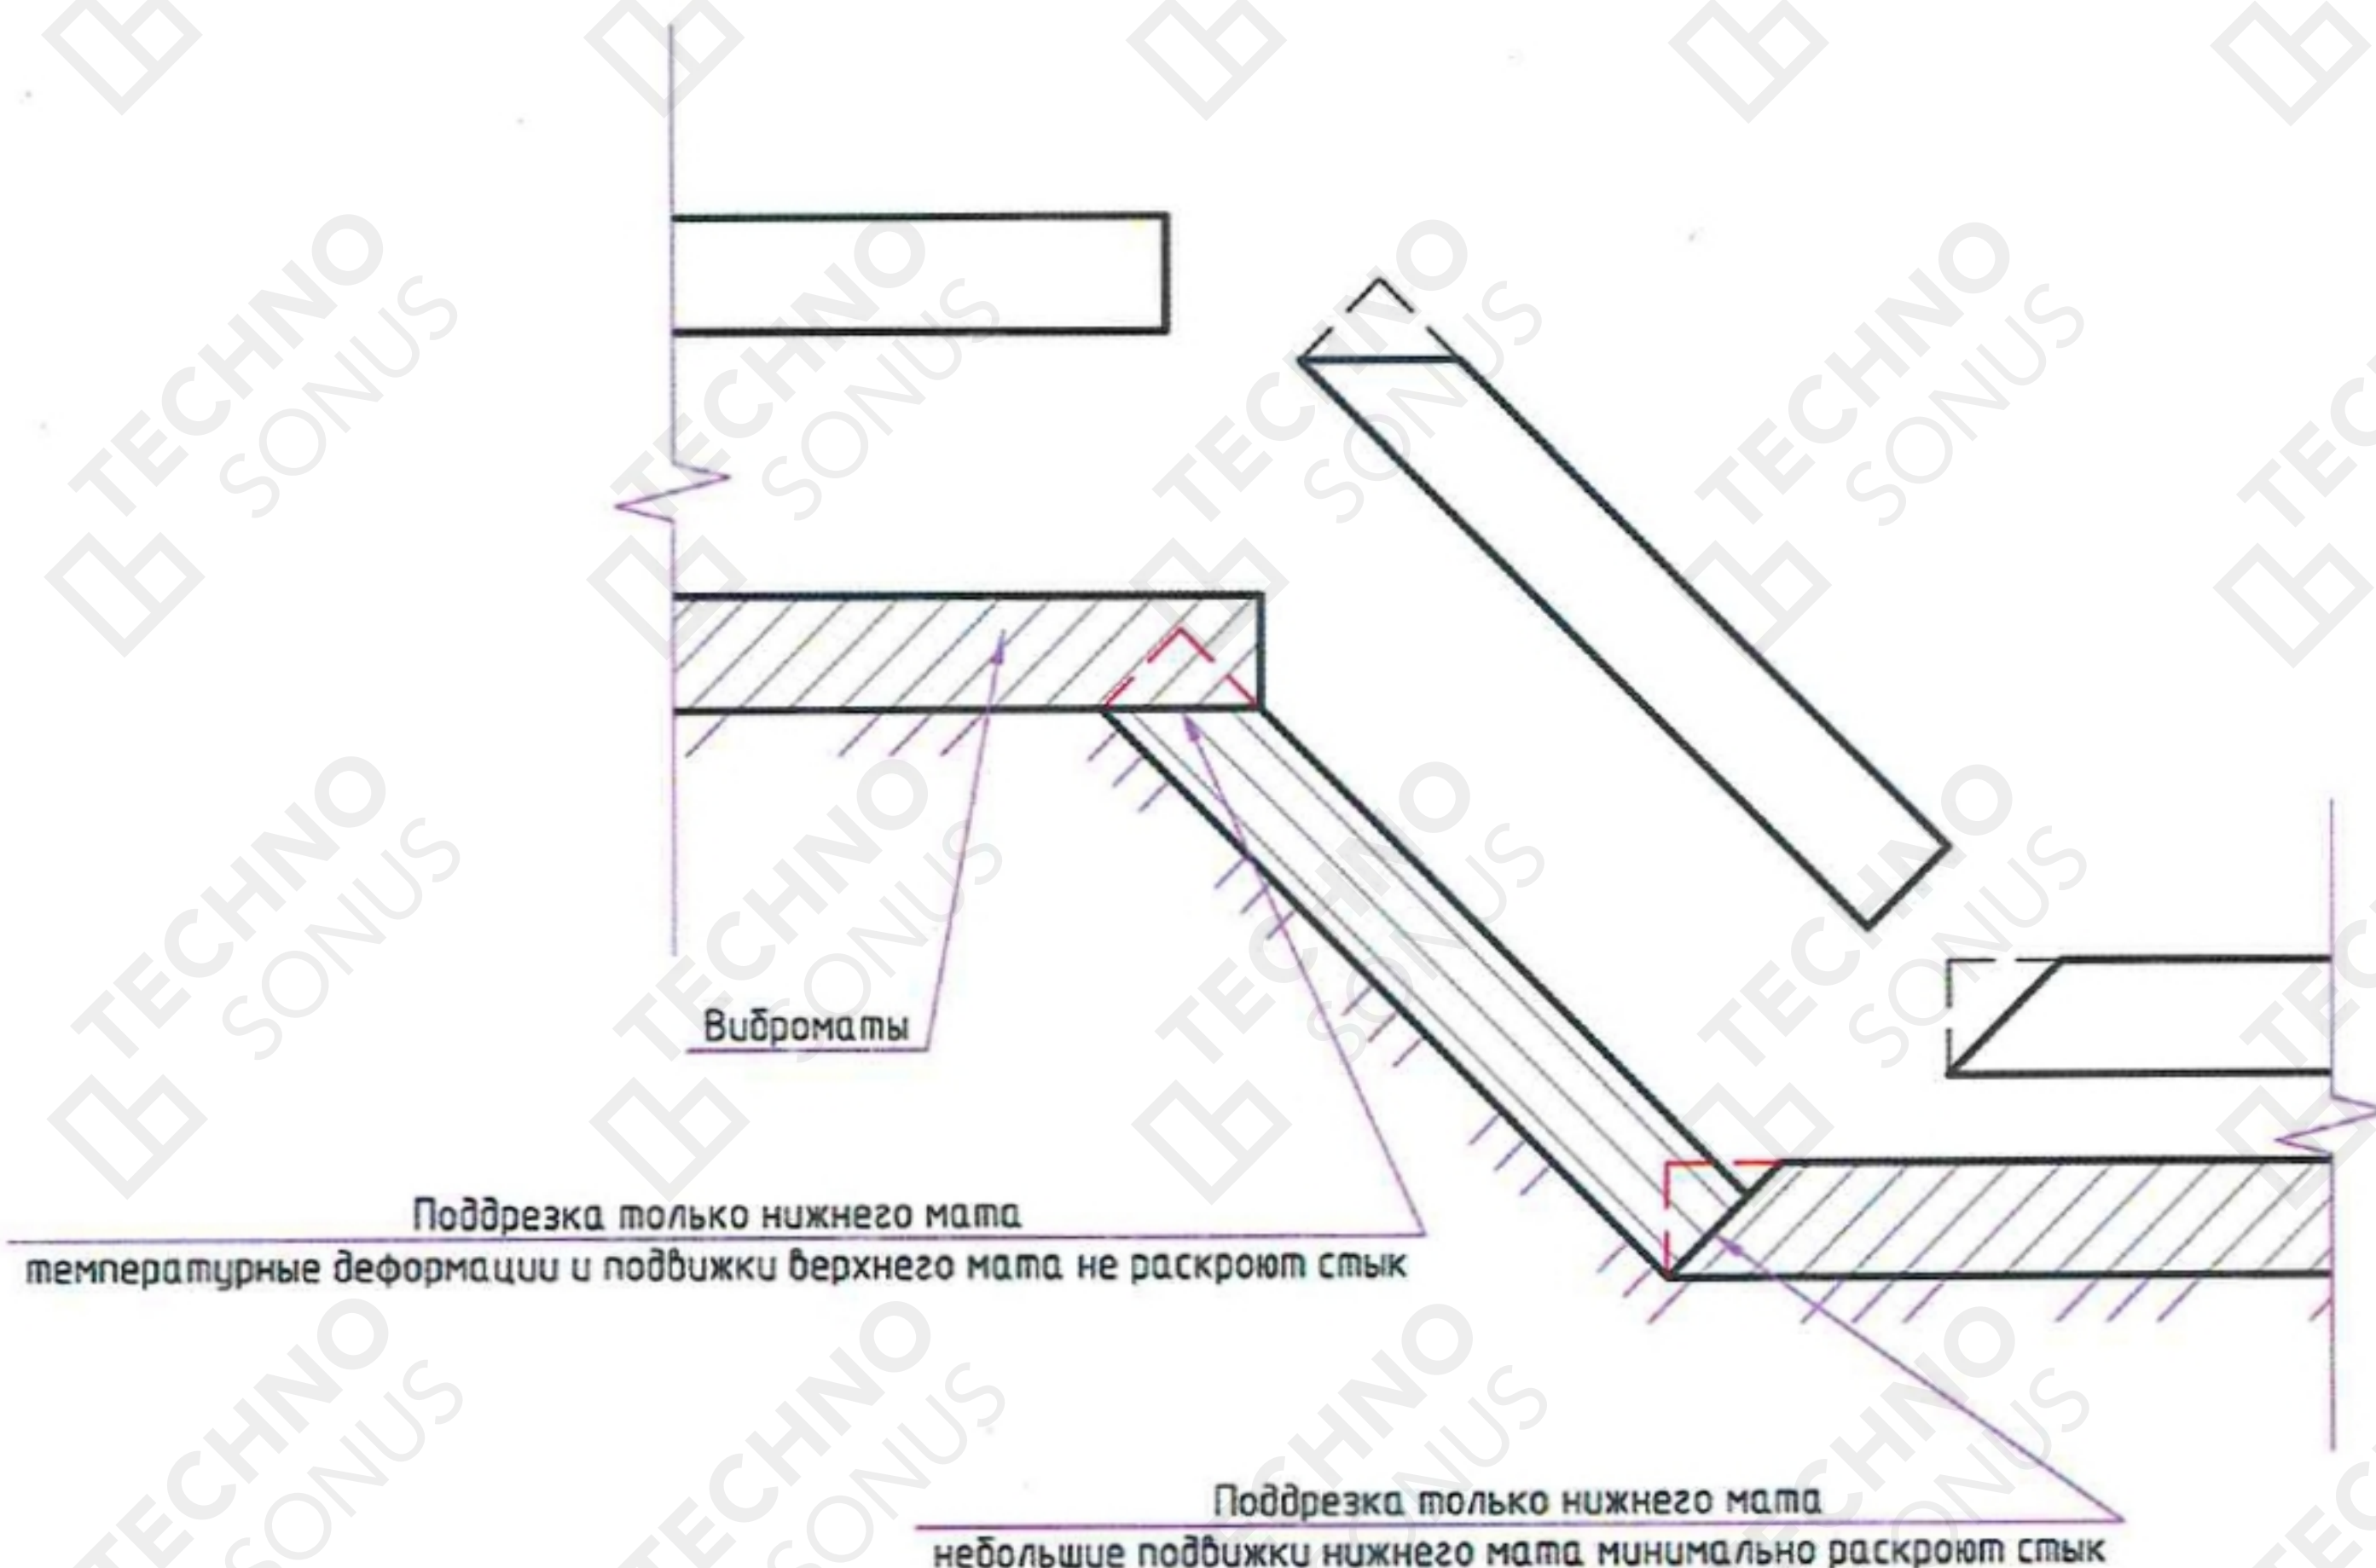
Рекомендованная схема подрезки матов на наклонных плоскостях под фундаментом
